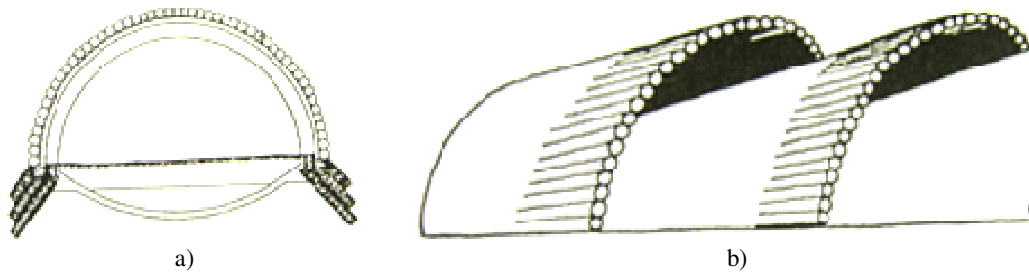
“Jet grouting” armado a) Vista transversal; b) Vista longitudinal (Roxo, 1995).
